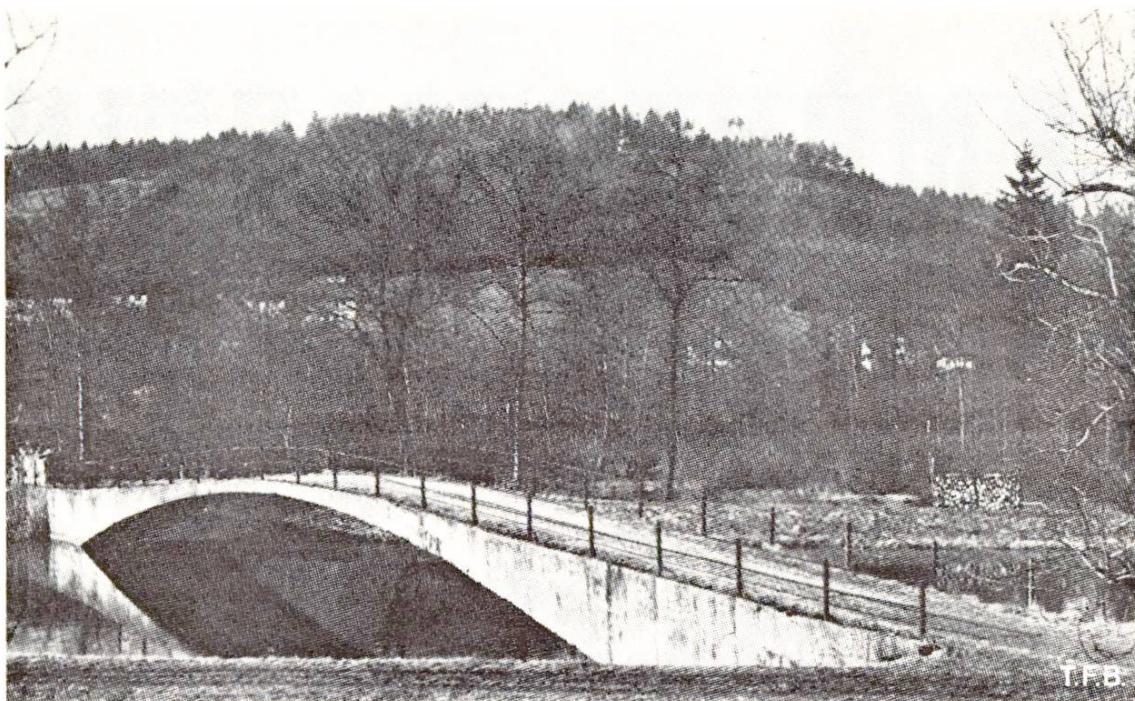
Die 1889/90 erbaute Betonbrücke über einen Fabrikkanal in Wildegg/AG.
